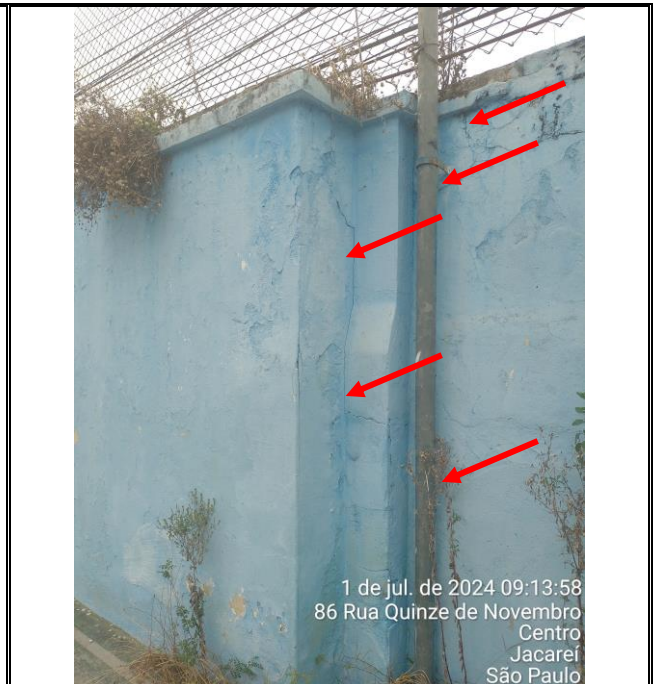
Muro de divisa com ponto de vista pelo lado interno do imóvel vistoriado;
